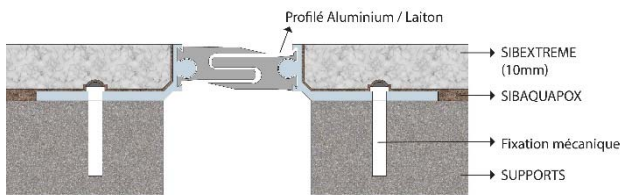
Traitement des joints de dilatation (par exemple avec profilé JOINTEC type Traffic strong JTS 78)
